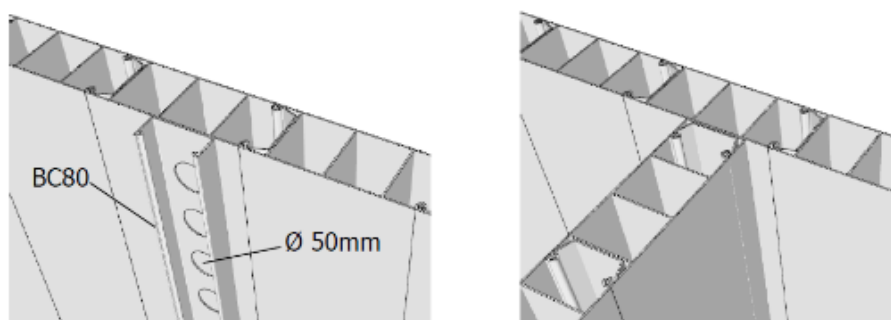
Perfil “BC 80”, com furos, utilizado para a fixação de paredes - ligação entre paredes do tipo “T”. (Sem escala)
